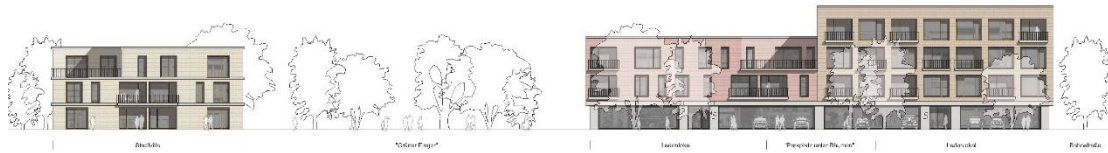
Vorentwurf | Ansicht „Parkplatz unter Bäumen“ © LECKE ARCHITEKTEN
